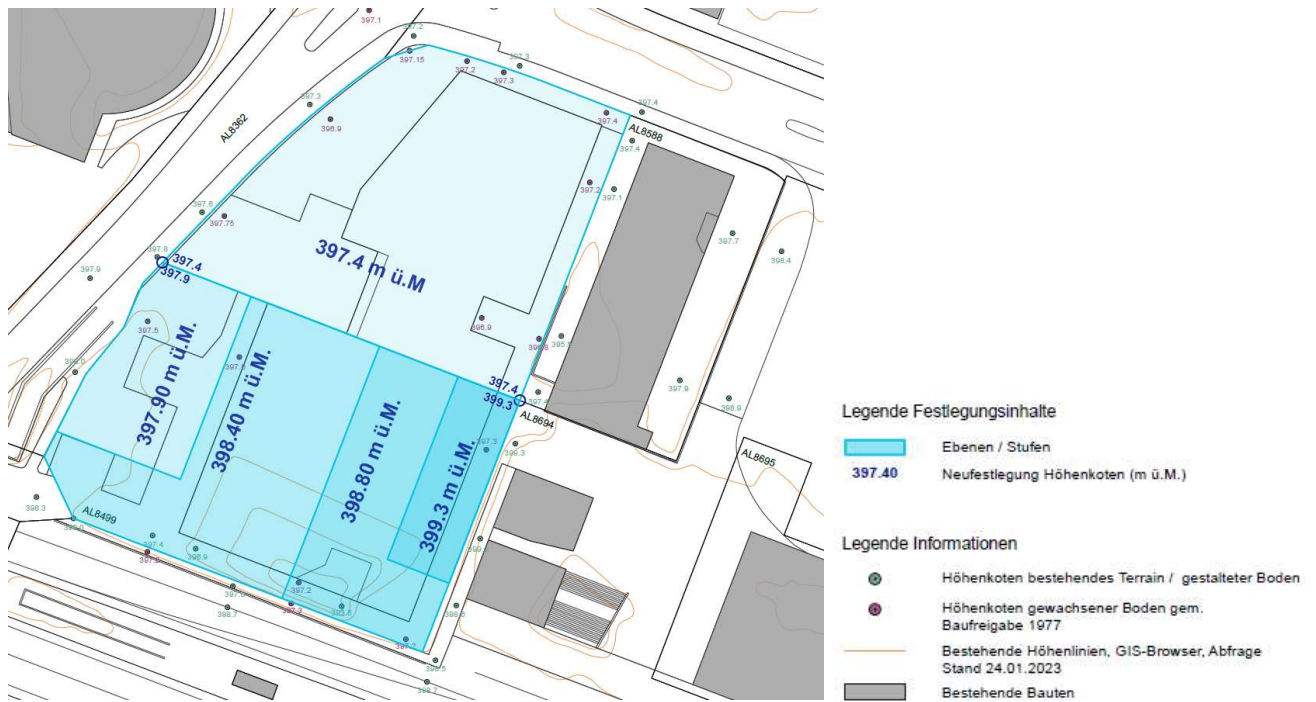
Grundlage Neudefinition gewachsener Boden, Ebenen, Planpartner AG, 27.01.2023
